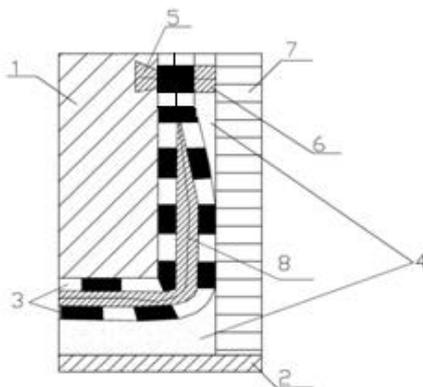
Пример оклеечной гидроизоляции подземного угла сооружения:
